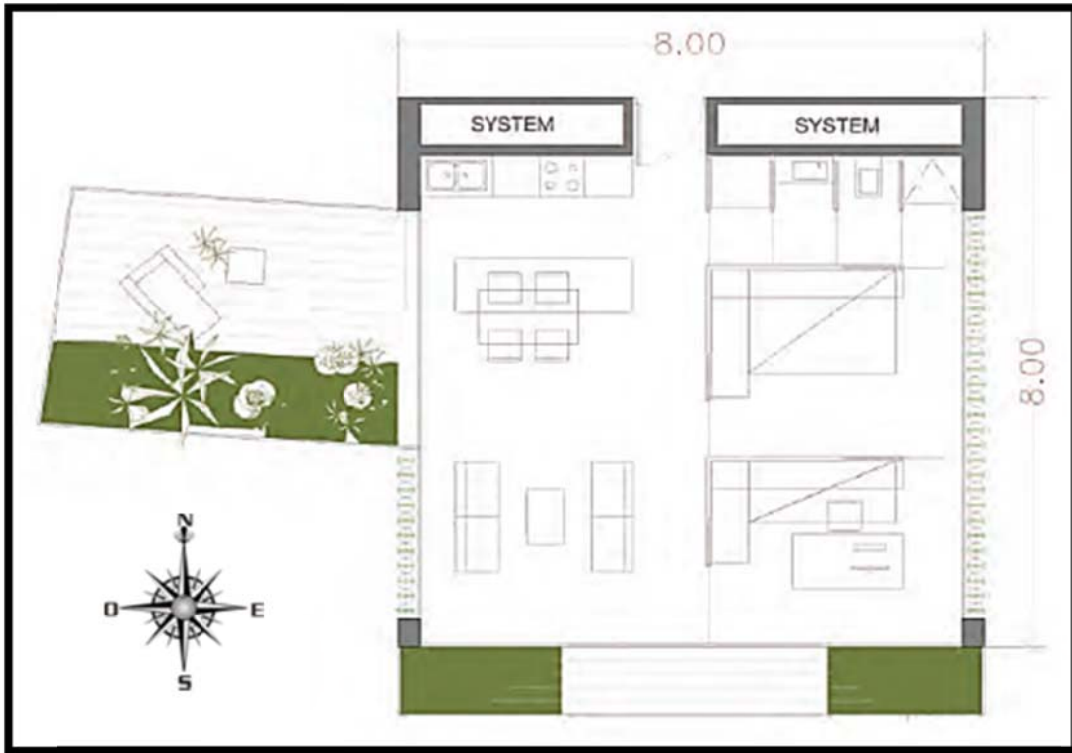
Plano planta primera propuesta VIA-UJI. Fuente: Equipo VIA-UJI.
